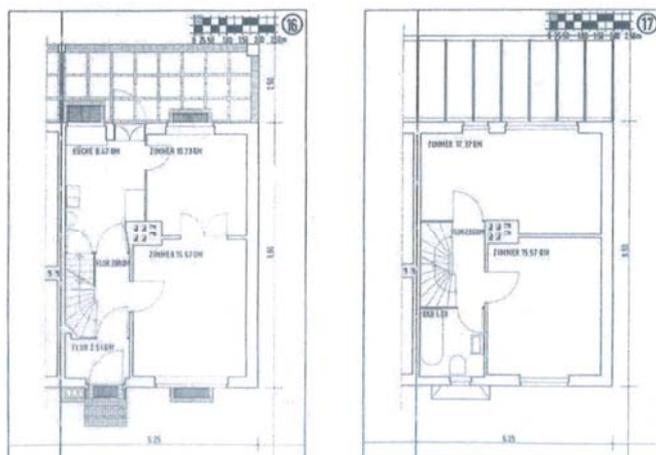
Grundrisse der Siedlung Onkel Toms Hütte
